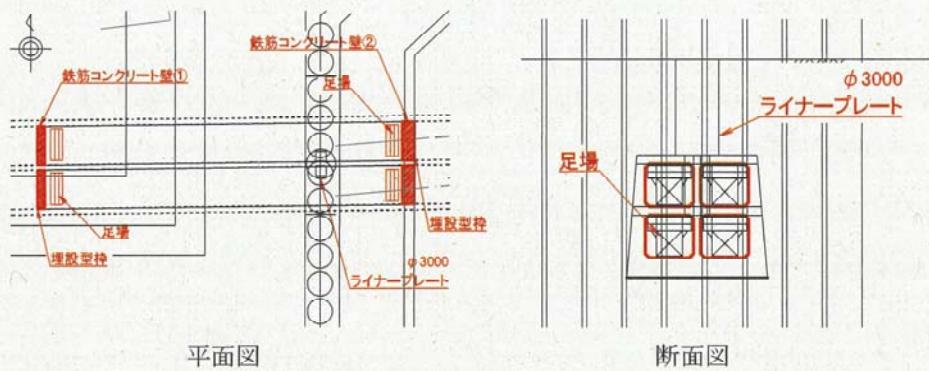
鉄筋コンクリート壁設置工計画図
